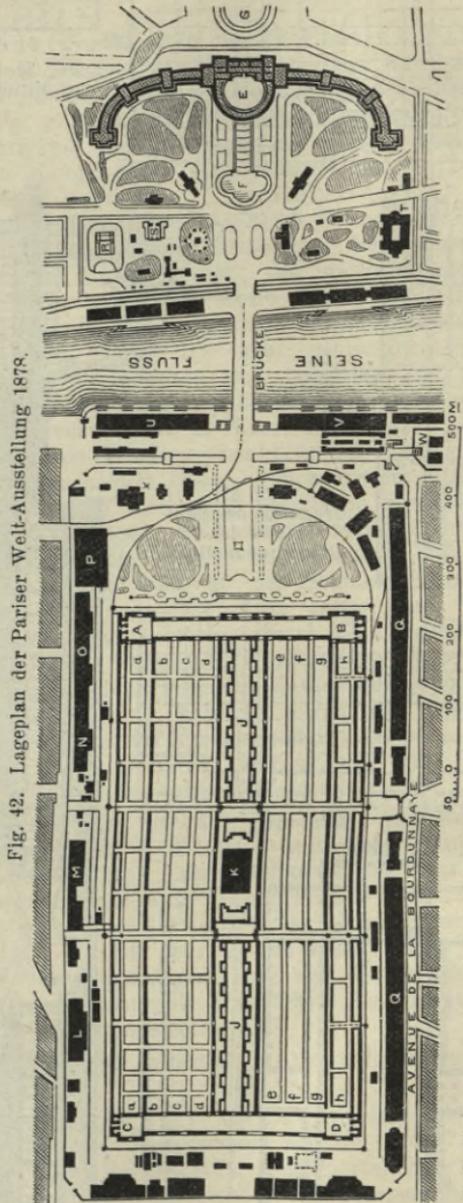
Lageplan der Pariser Welt-Ausstellung 1878.
